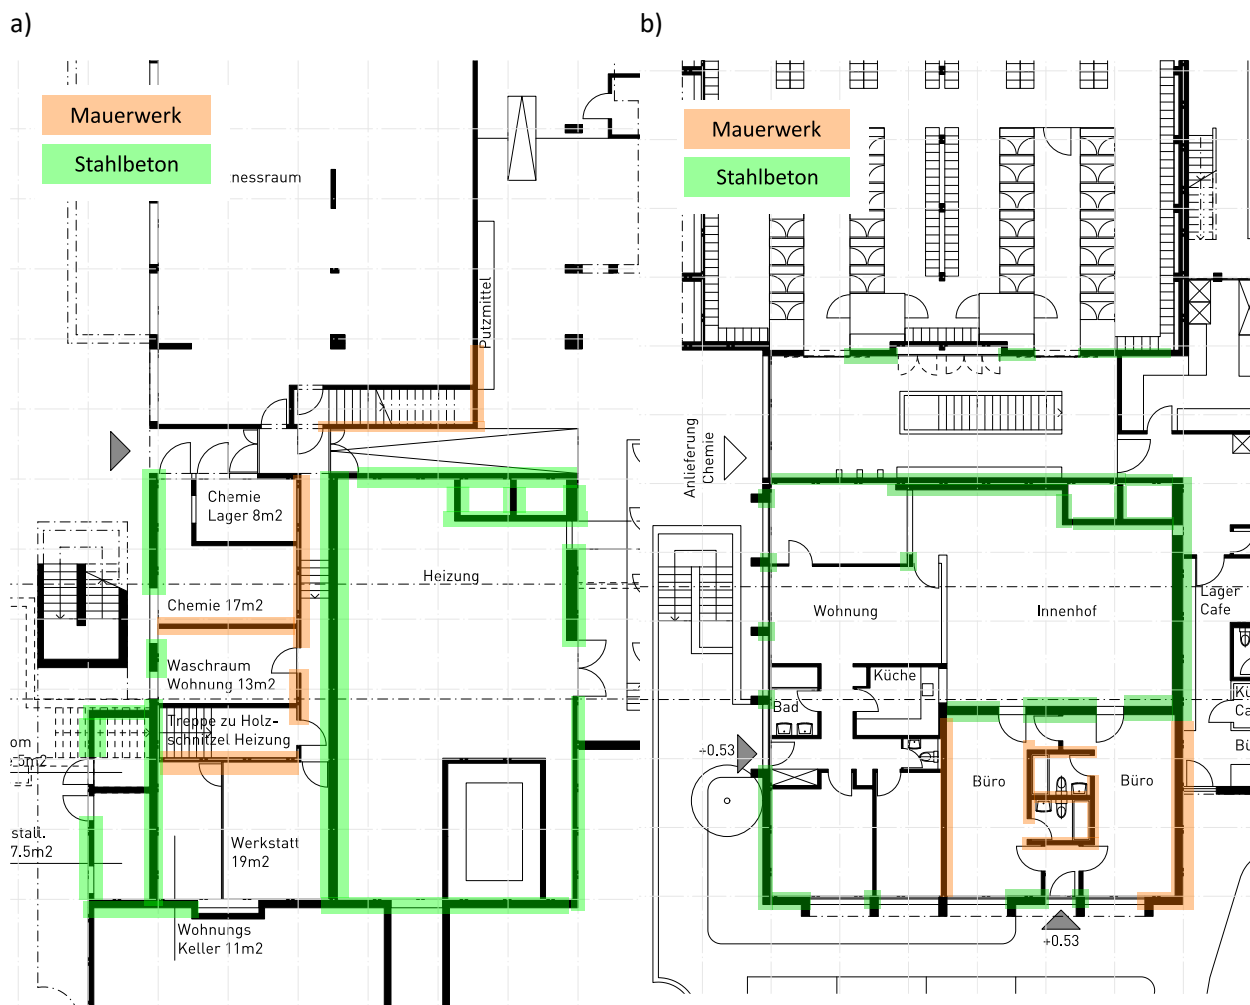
Stützen und tragende Wände im a) Untergeschoss und b) Erdgeschoss
